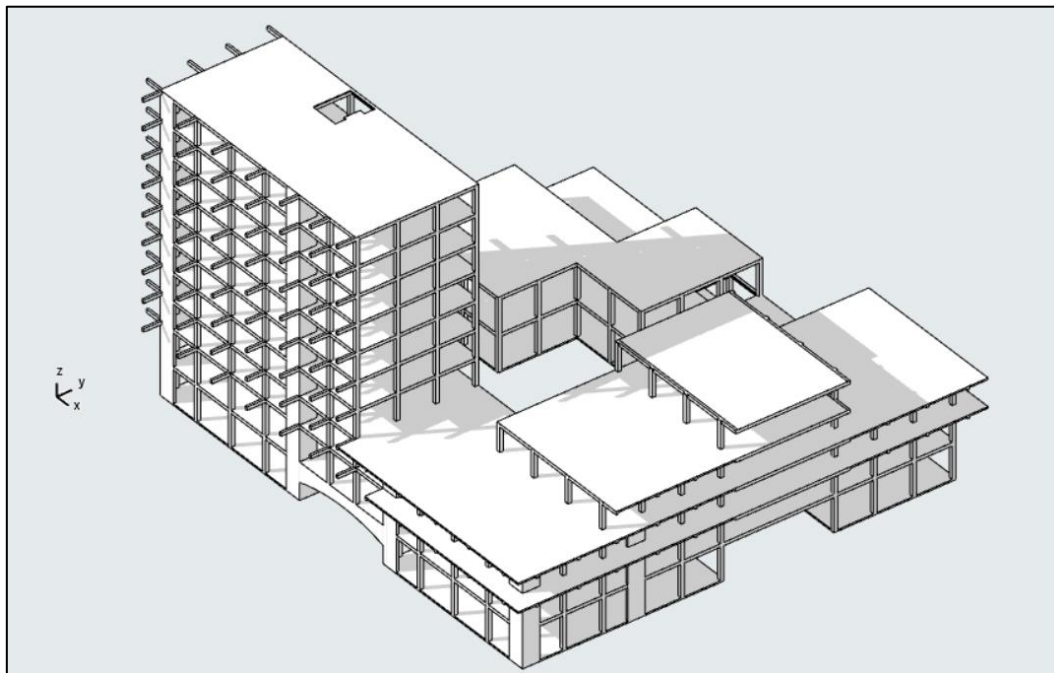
3D du système structurel ; Source : traité par l'auteur
